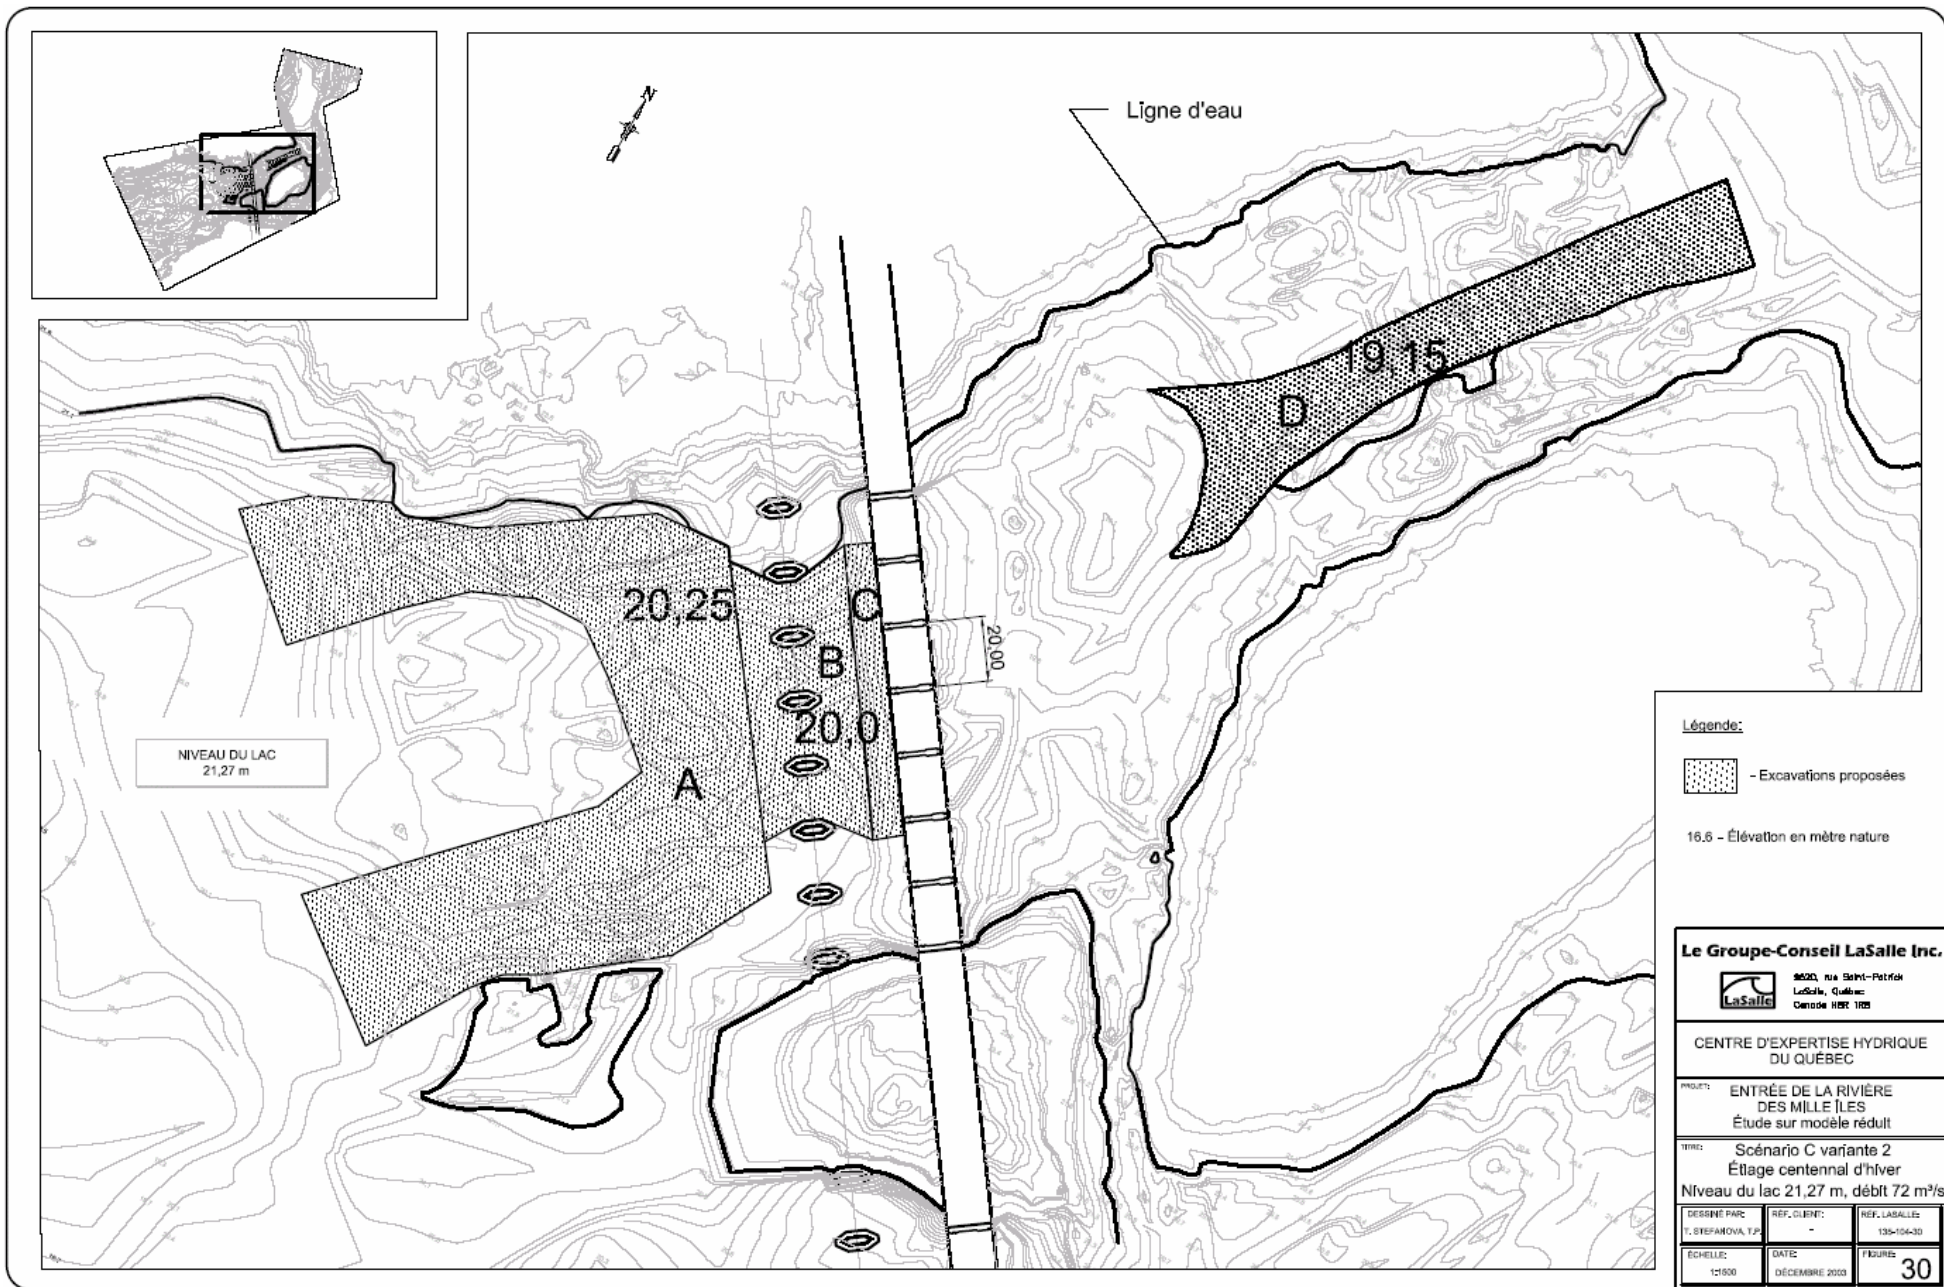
Scénario d'excavation C-72 m<sup>3</sup>/s – Variante 2 (source : Groupe-conseil Lasalle inc.)
